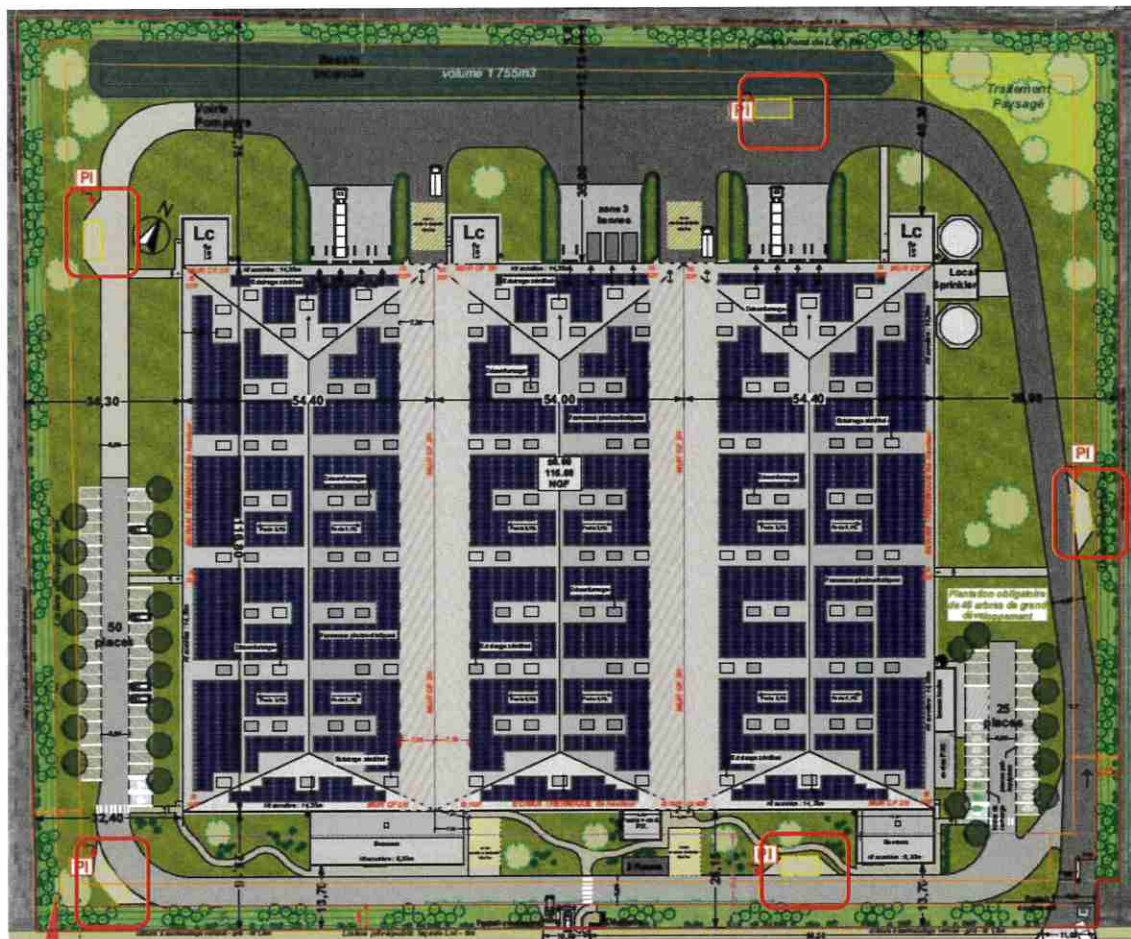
Plan masse avec visualisation des poteaux incendie et des aires de stationnement associées
